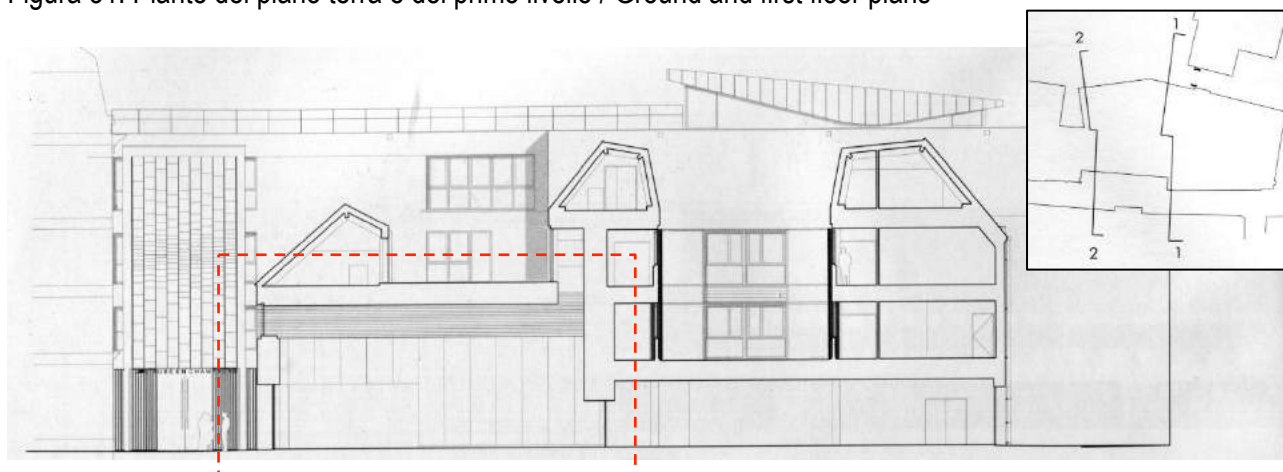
Sezione trasversale 1 / Longitudinal section 1
